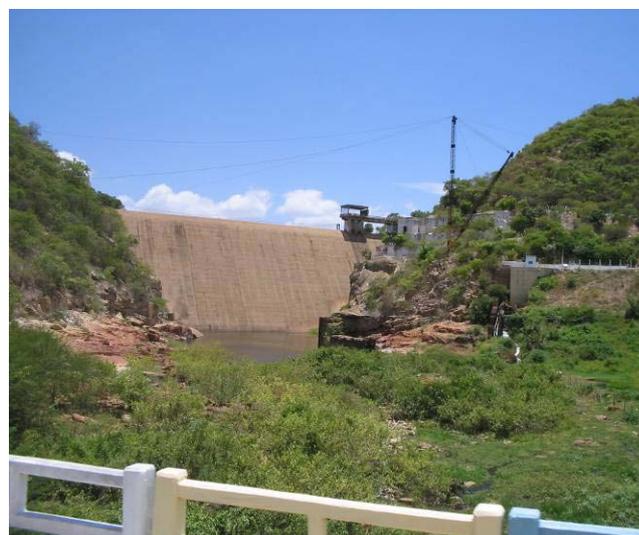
Barragem do Sistema Coremas Mãe d'água em fevereiro de 2006.
